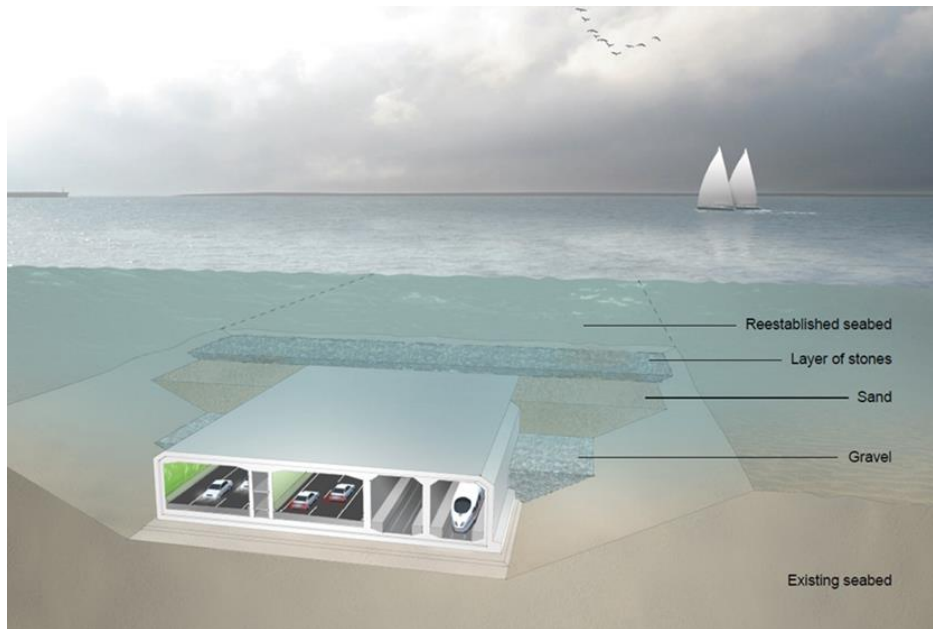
Zanja de excavación, elemento prefabricado del túnel y las distintas capas de relleno de un túnel sumergido. Sección del túnel Fehmarnbelt. Imagen: Arup.com
